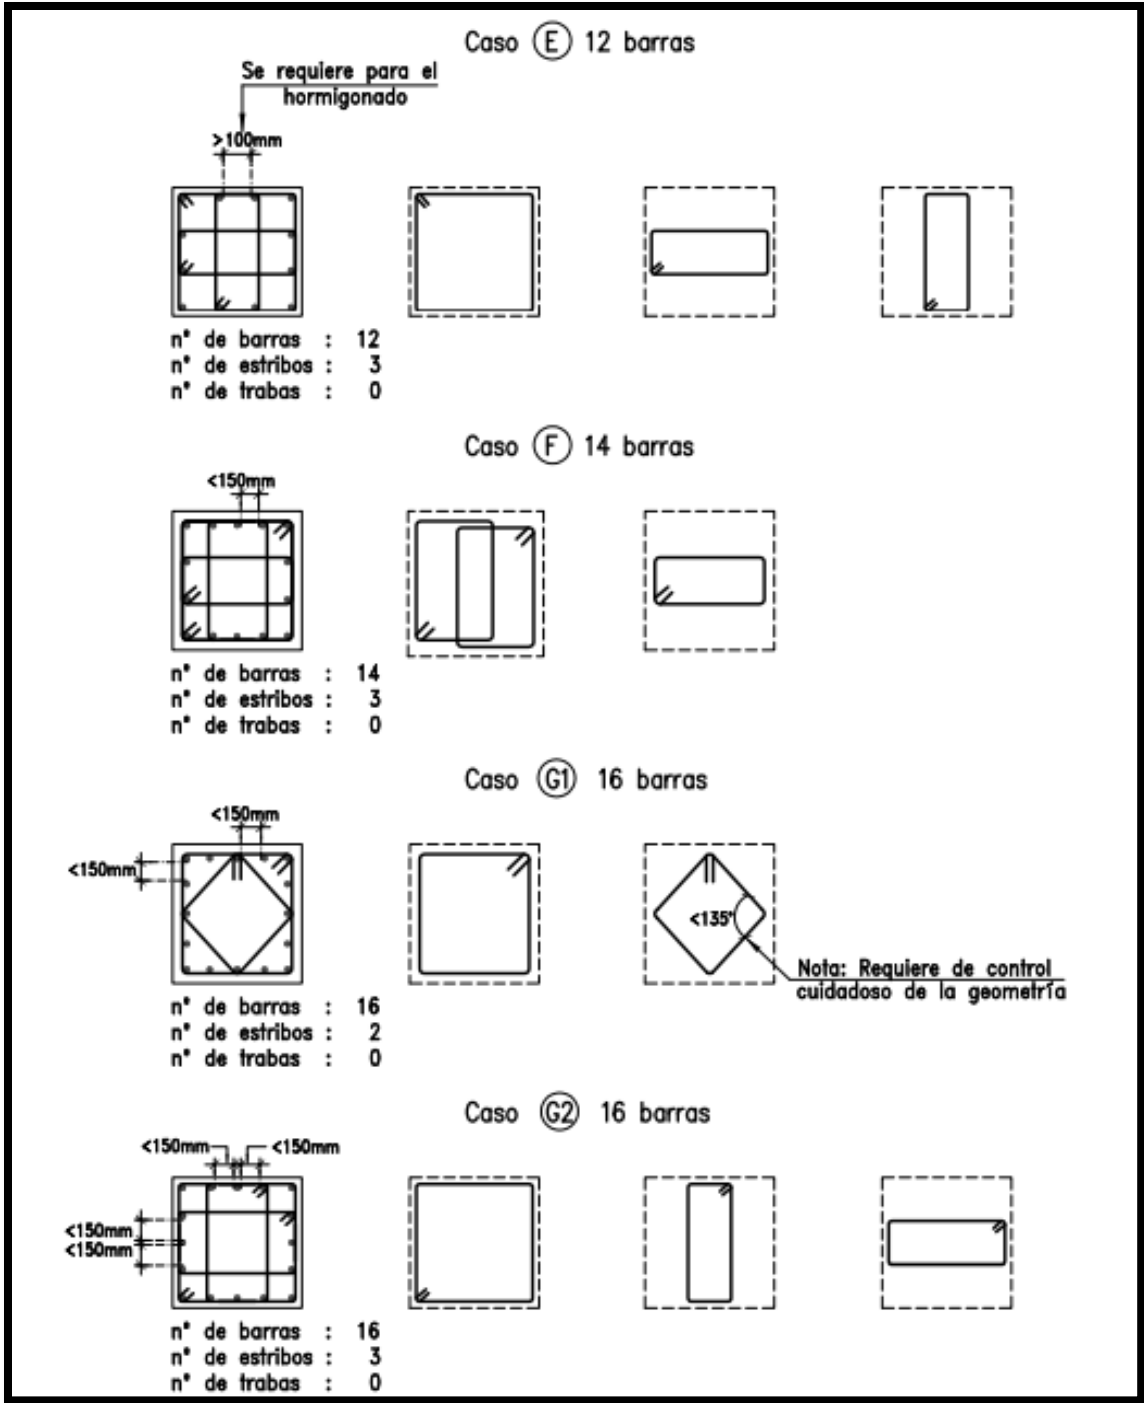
Secciones Típicas de Columnas (E-G2)
